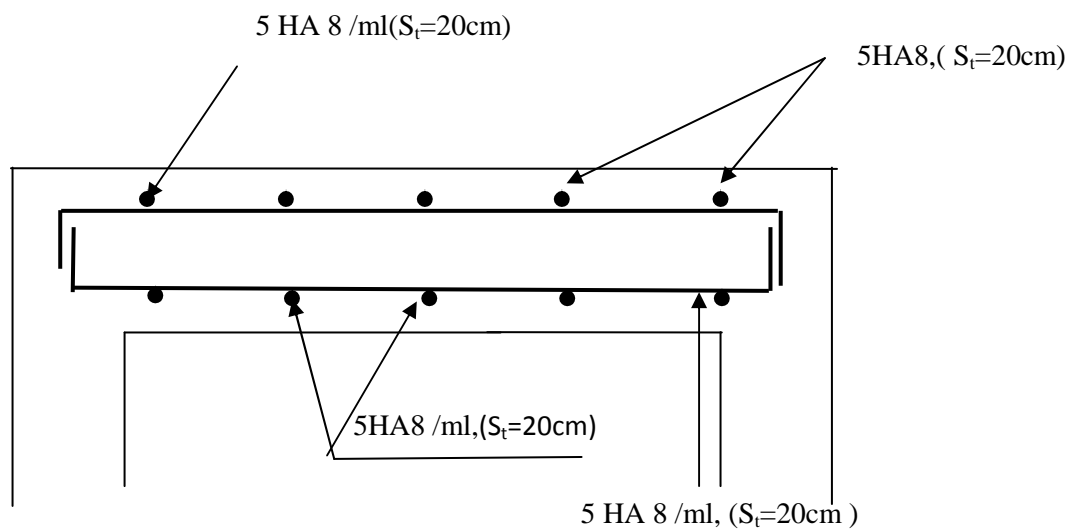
Ferrailage de la dalle pleine de la salle machine dans le sens y-y.
